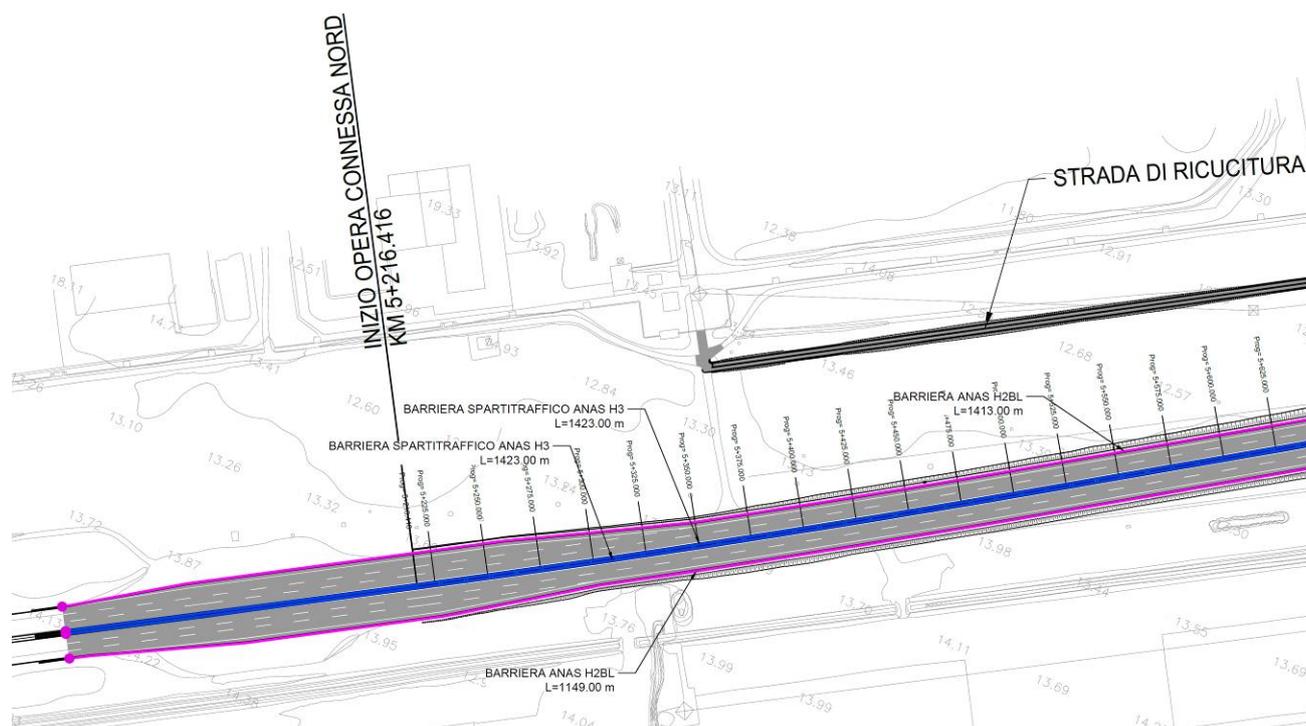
Stralcio Sistemazione corsie specializzate e piazzali esistenti (Planimetria barriere di sicurezza dal km 5+216 al km 6+900)
